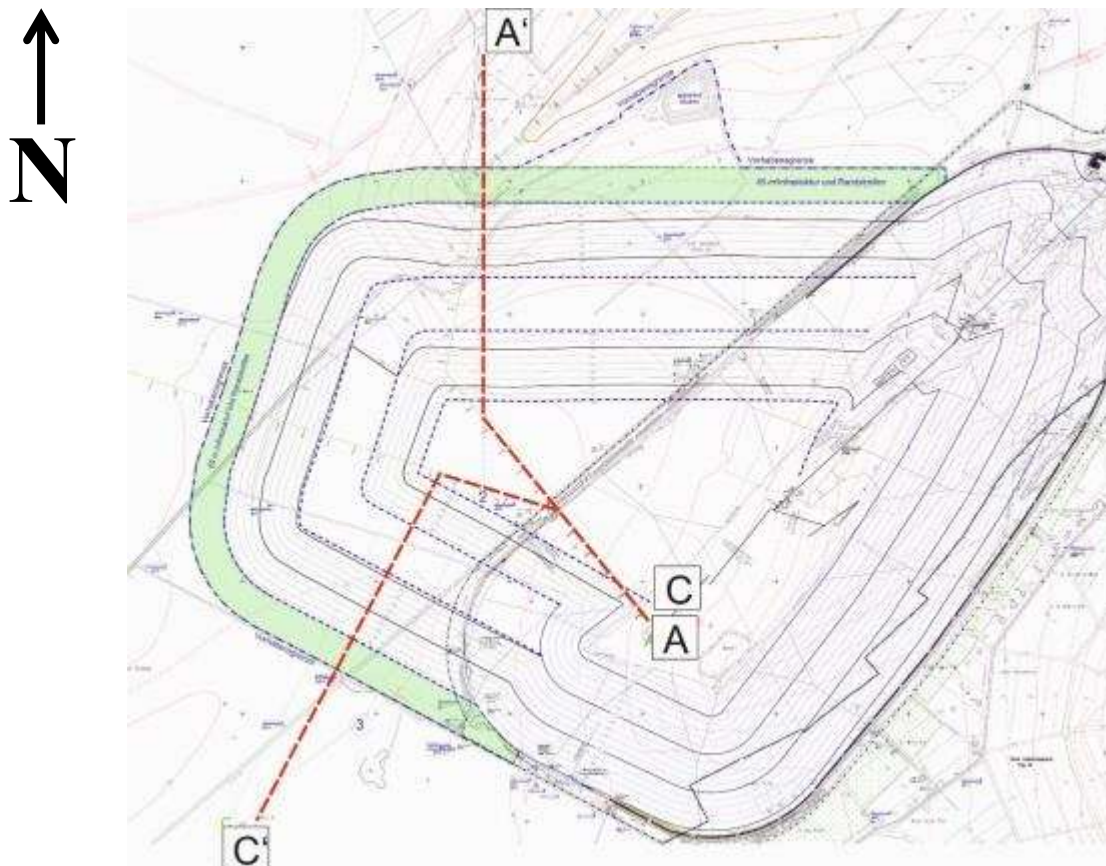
Lageplan der genehmigten Halde Hattorf und der geplanten, nordwestlich gelegenen Erweiterungsfläche mit den Untersuchungsschnitten A-A'₂₀₁₈ und C-C'₂₀₁₈
